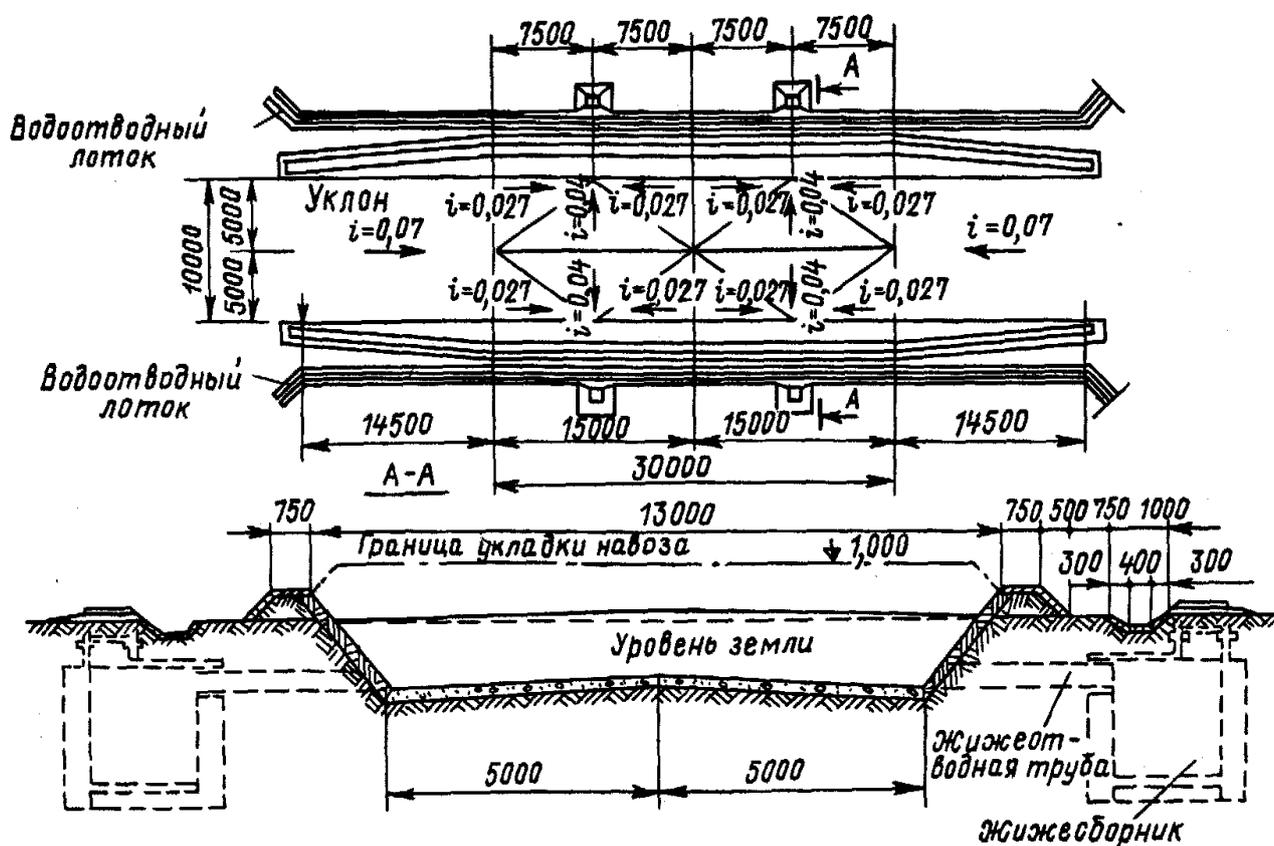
Поперечный разрез полузаглубленного навозохранилища
